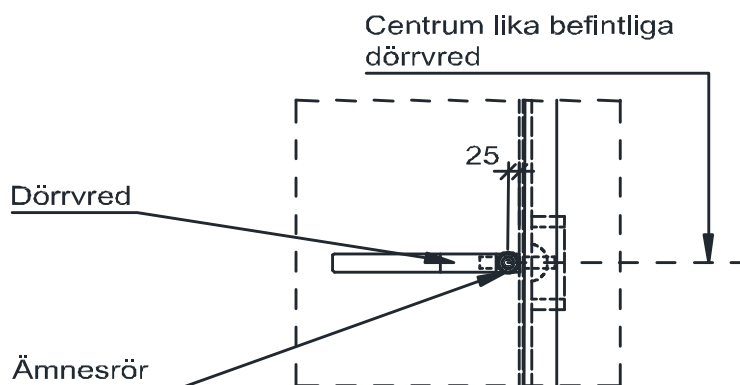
Plan av dörrvred vid ej betongfyllt dörrblad
